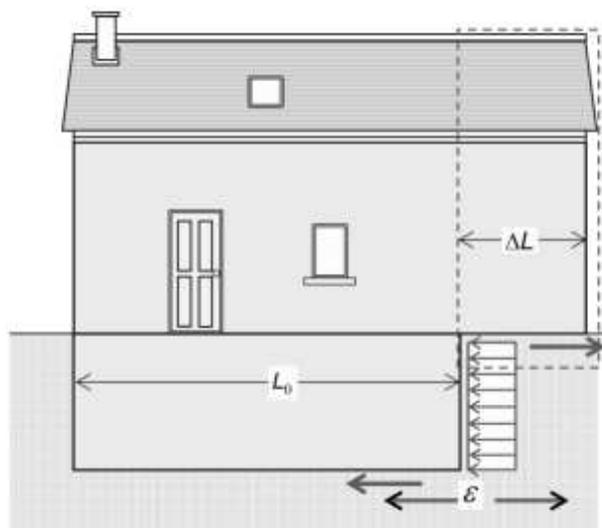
exemple de sollicitations supplémentaires sur la partie enterrée
